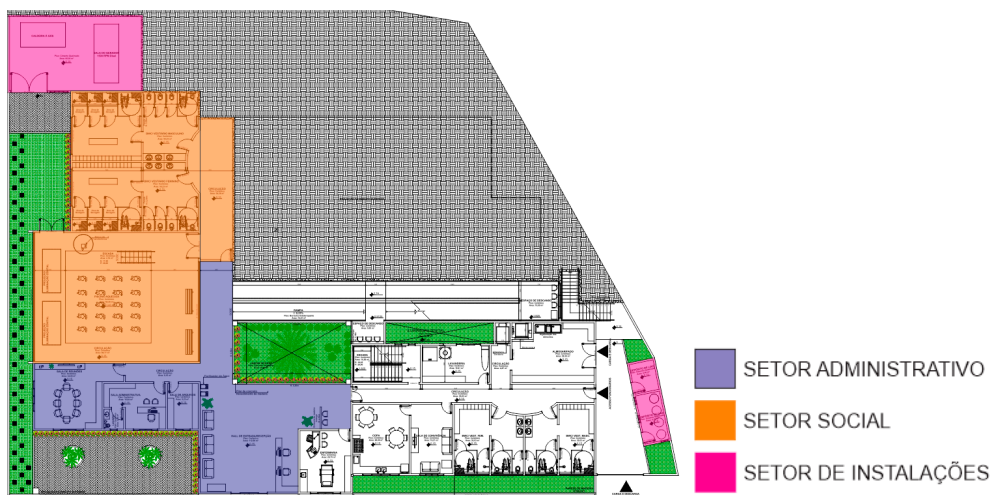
Planta Baixa do Setor Administrativo, Social e Instalações.
